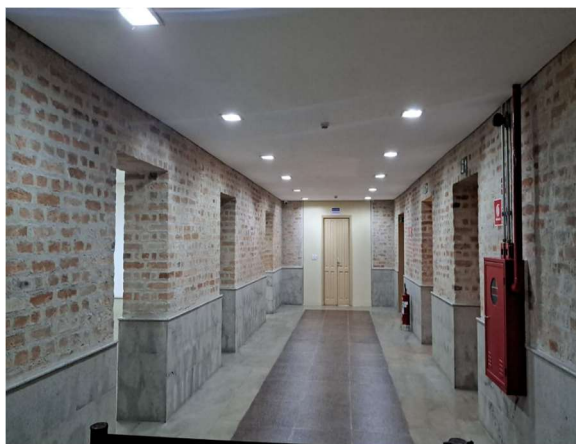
Conservação, pintura forro hall pavimento inferior.
